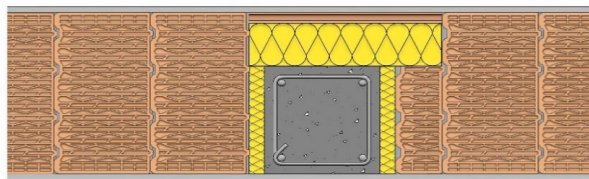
Sezione orizzontale della risoluzione del ponte termico in corrispondenza del pilastro.
